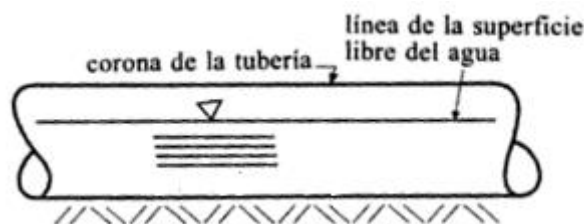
Tubería. (Fuente: Biérre & Pizarro, 2008).
